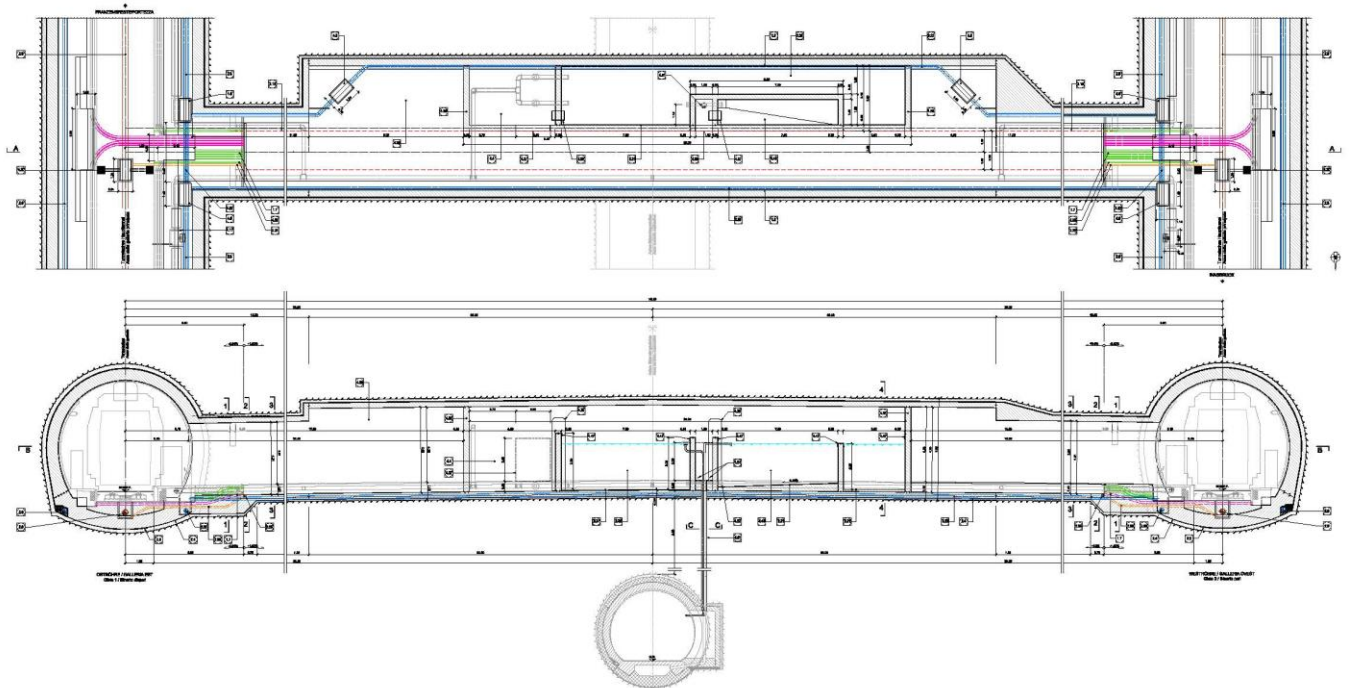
Querstollen Typ 3 (BP 45/3) - Grundriss und Längsquerschnitt
